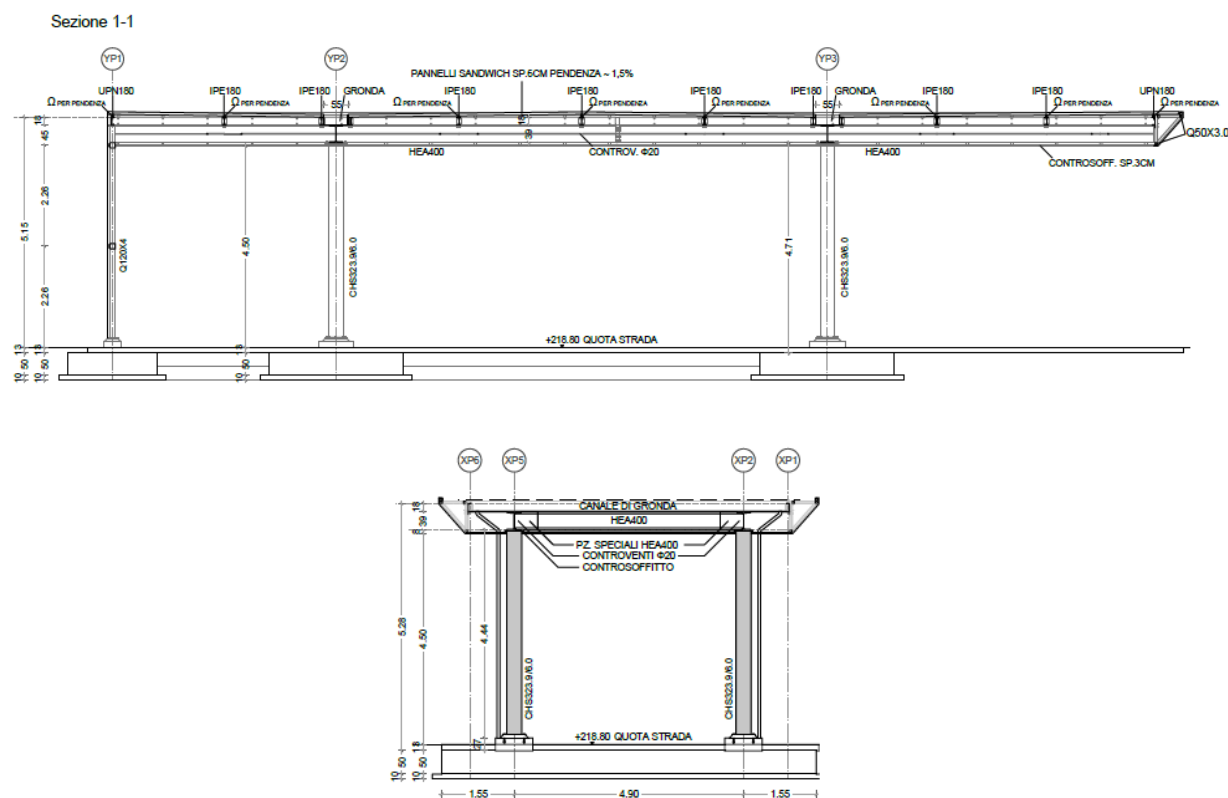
Prospetto longitudinale e trasversale del modello di pensilina proposto
